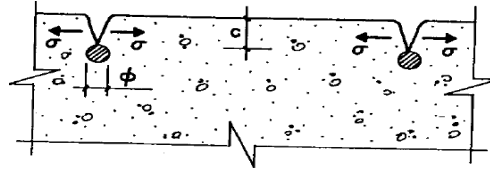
Fisuras debidas a vacios debajo de las armaduras.
